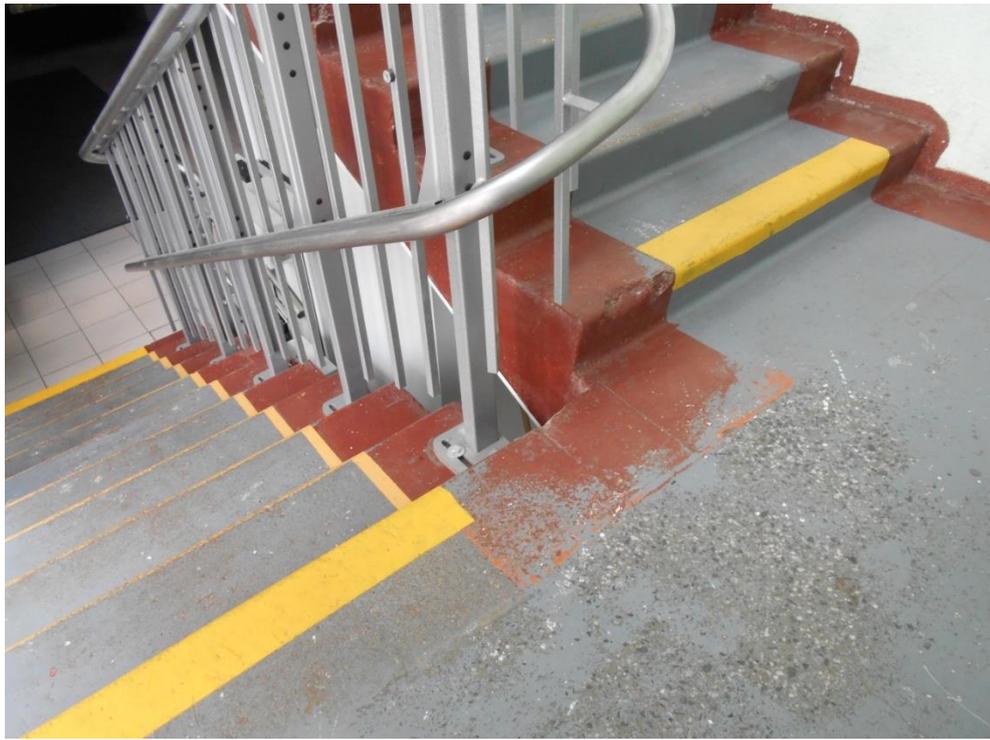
Лестничная площадка 2ЛК 1-2 этаж. Подъемник. На плане № 14.
